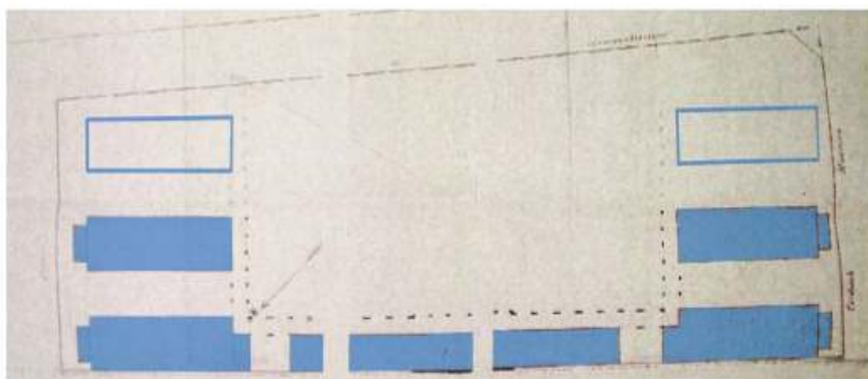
Pianta progetto originario non realizzato archivio storico città di Torino, pratica edilizia
